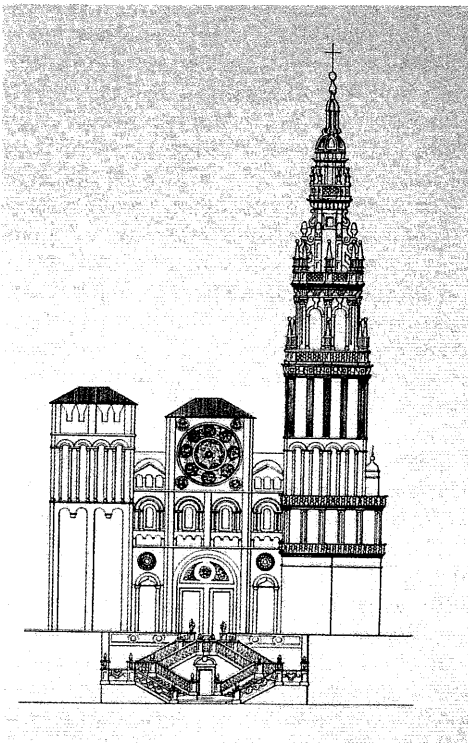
Reconstitución conjetural de la fachada del Obradoiro con la Torre de las Campanas (Dibujo de Vicente Vigo).
